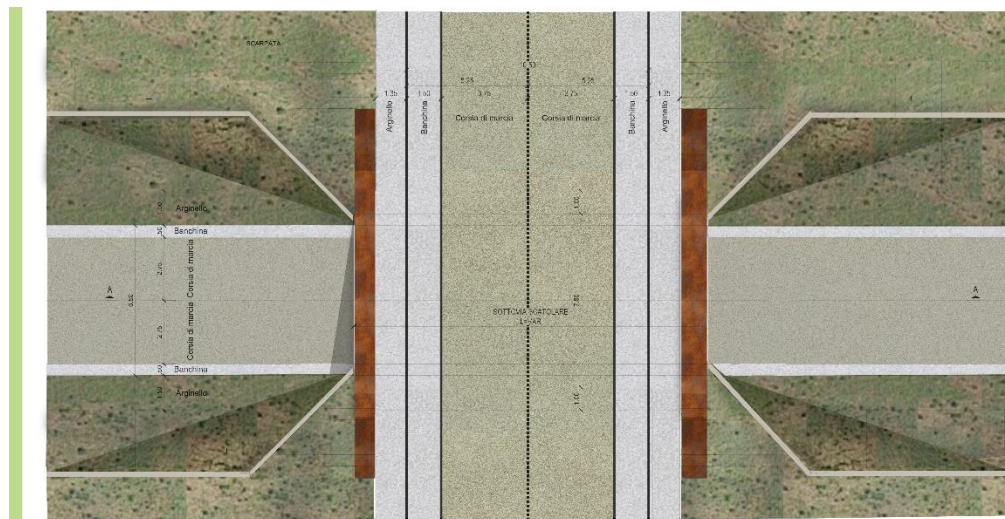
planimetria tipologica di sottovia viabilità poderale
